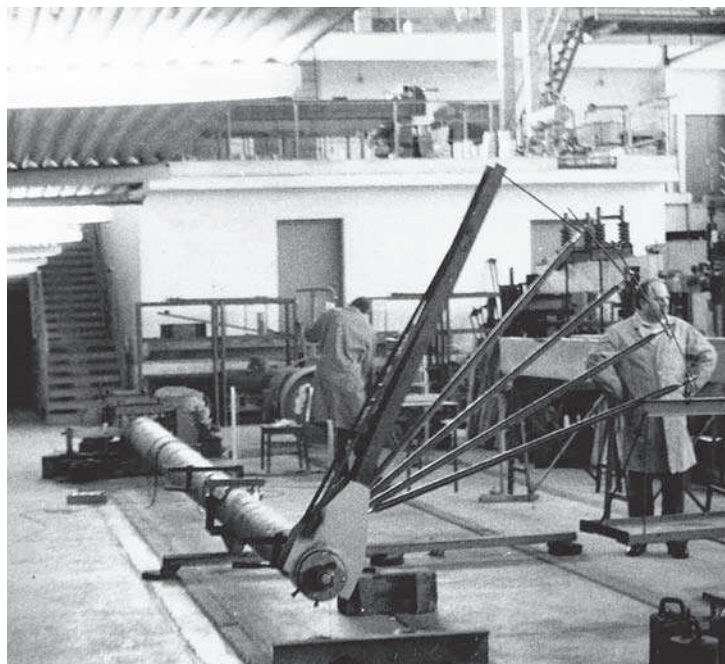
Badania poligonowe strunobetonowych żerdzi wirowanych E12/10
